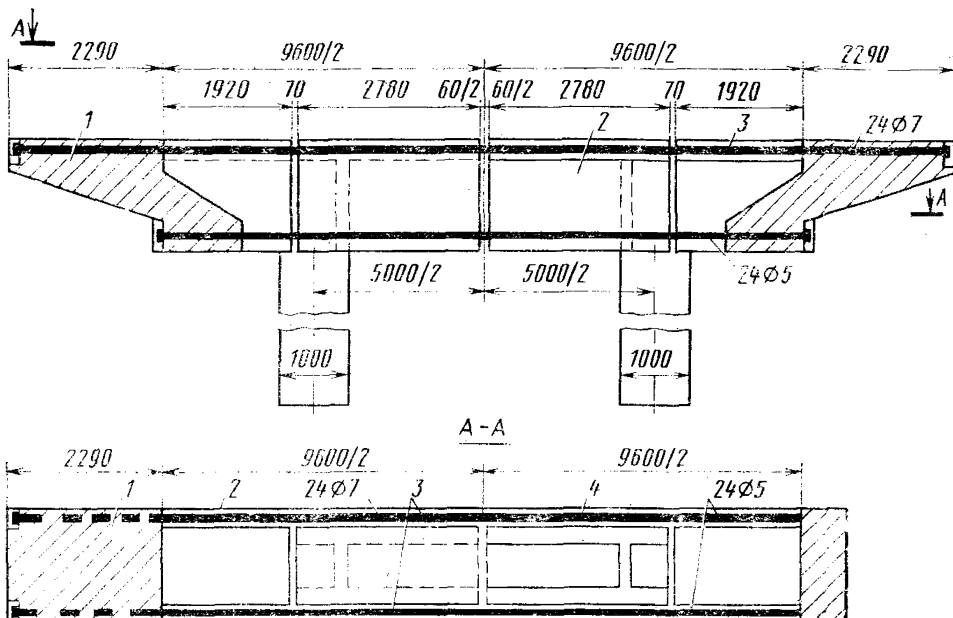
Расположение дополнительных железобетонных блоков и напрягаемой арматуры в уширенной опоре:
